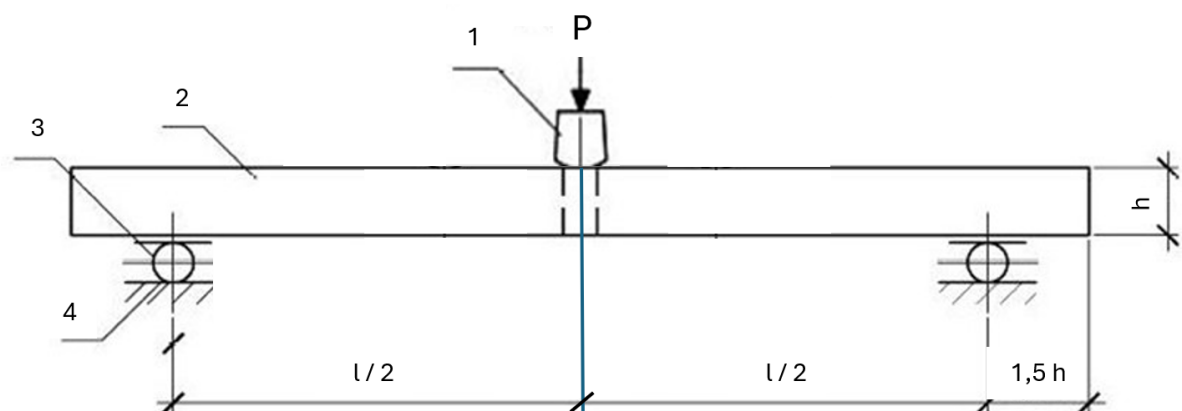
Схема визначення міцності клейового з'єднання на зубчастий шип.
